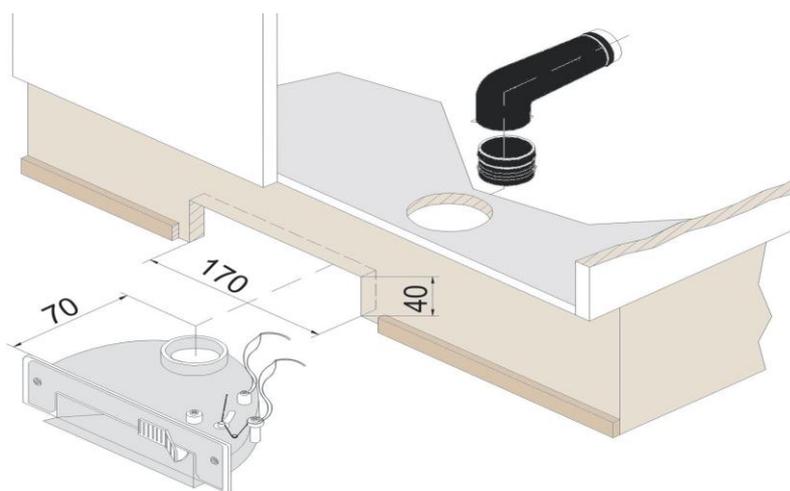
Instalação de tomada de recolha de cozinha (Allway)
